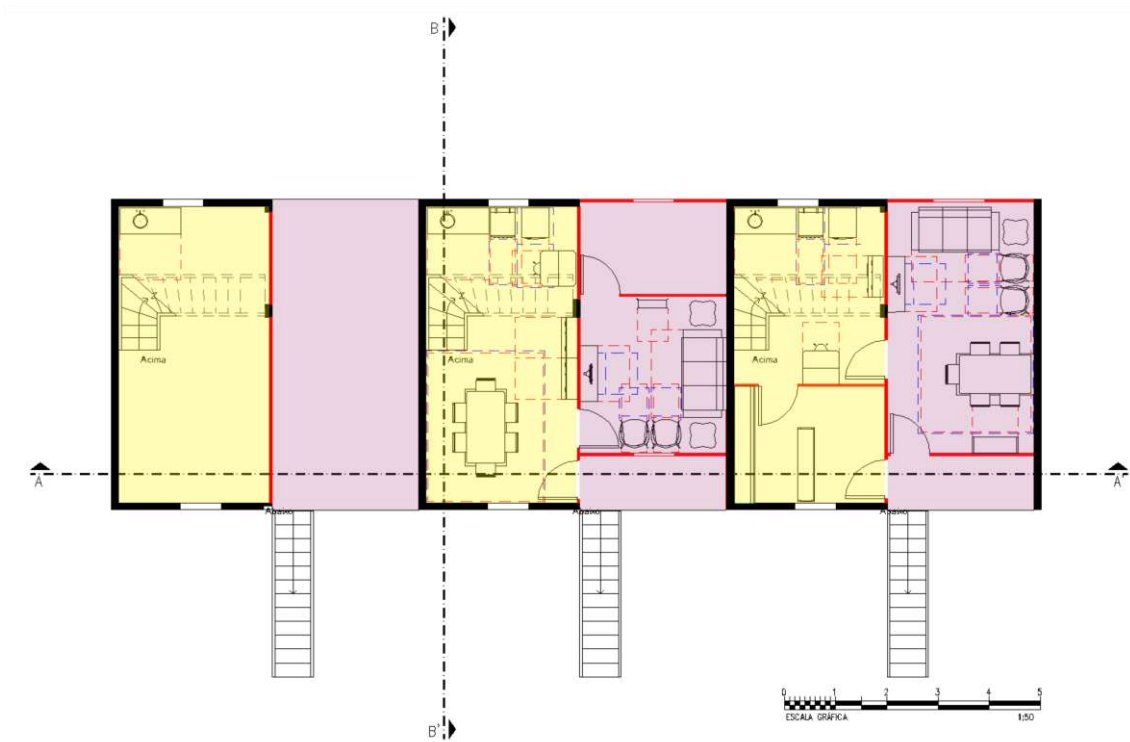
Planta do primeiro pavimento que compõe as unidades duplex com possíveis modificações geradas no modelo BIM -
